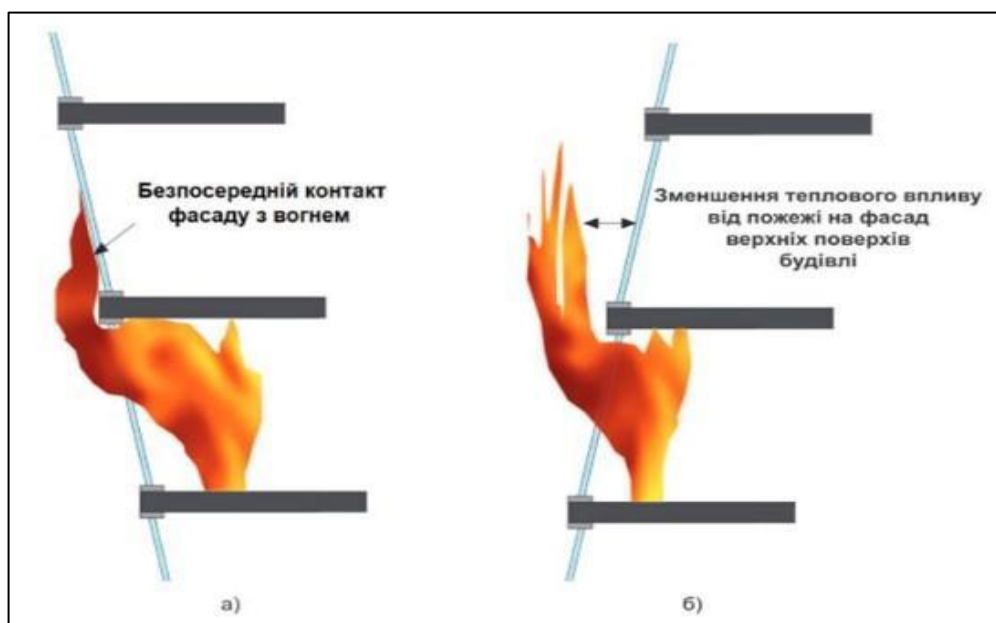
Приклади теплового впливу пожежі на фасад будівлі за кута ухилу площини фасаду відносно горизонталі (або площини перекриття будівлі):
